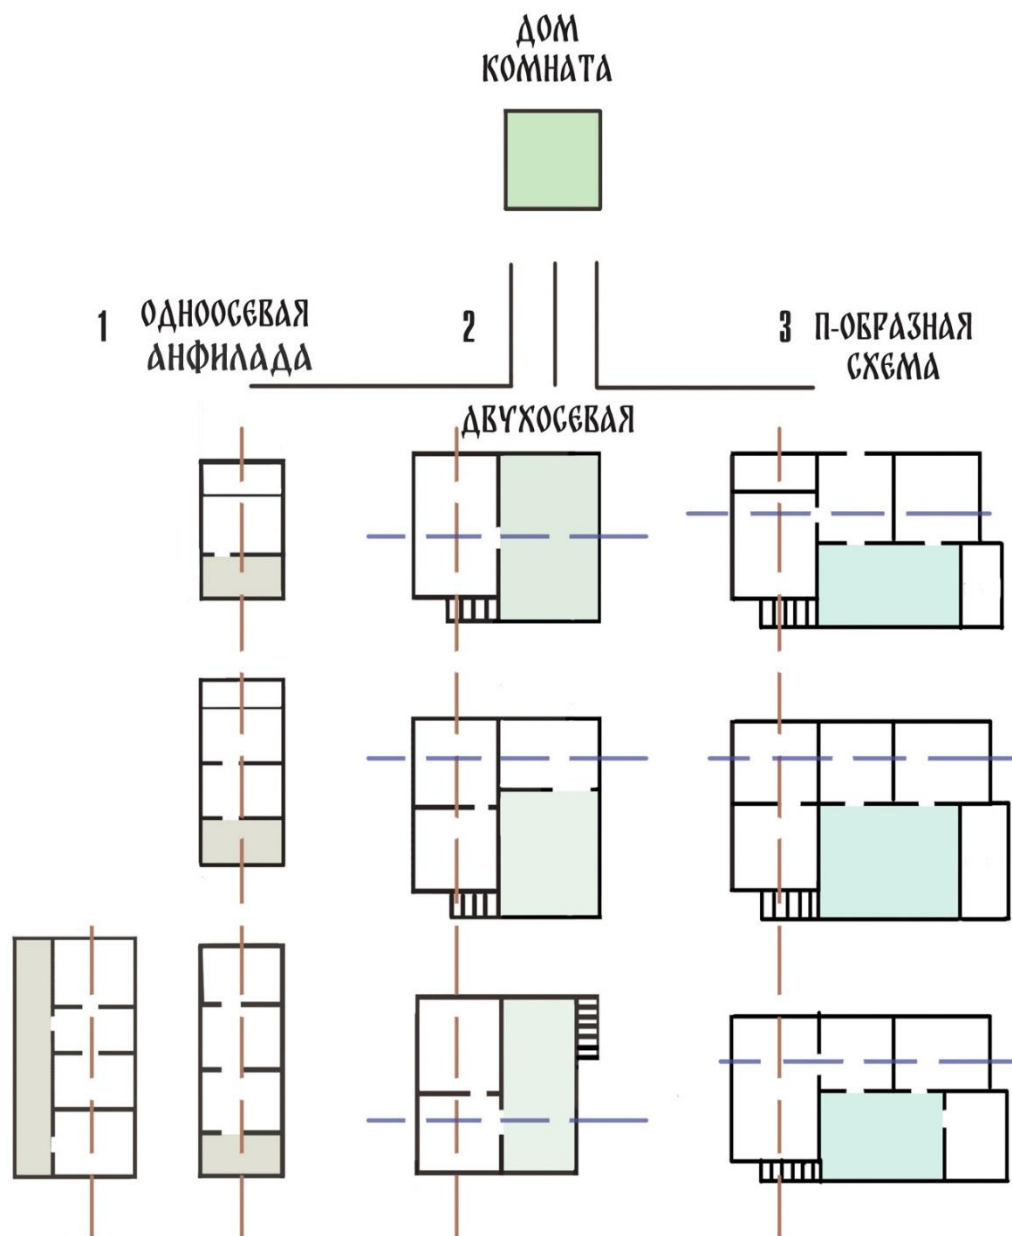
Развитие объемно- планировочной схемы жилого дома.
